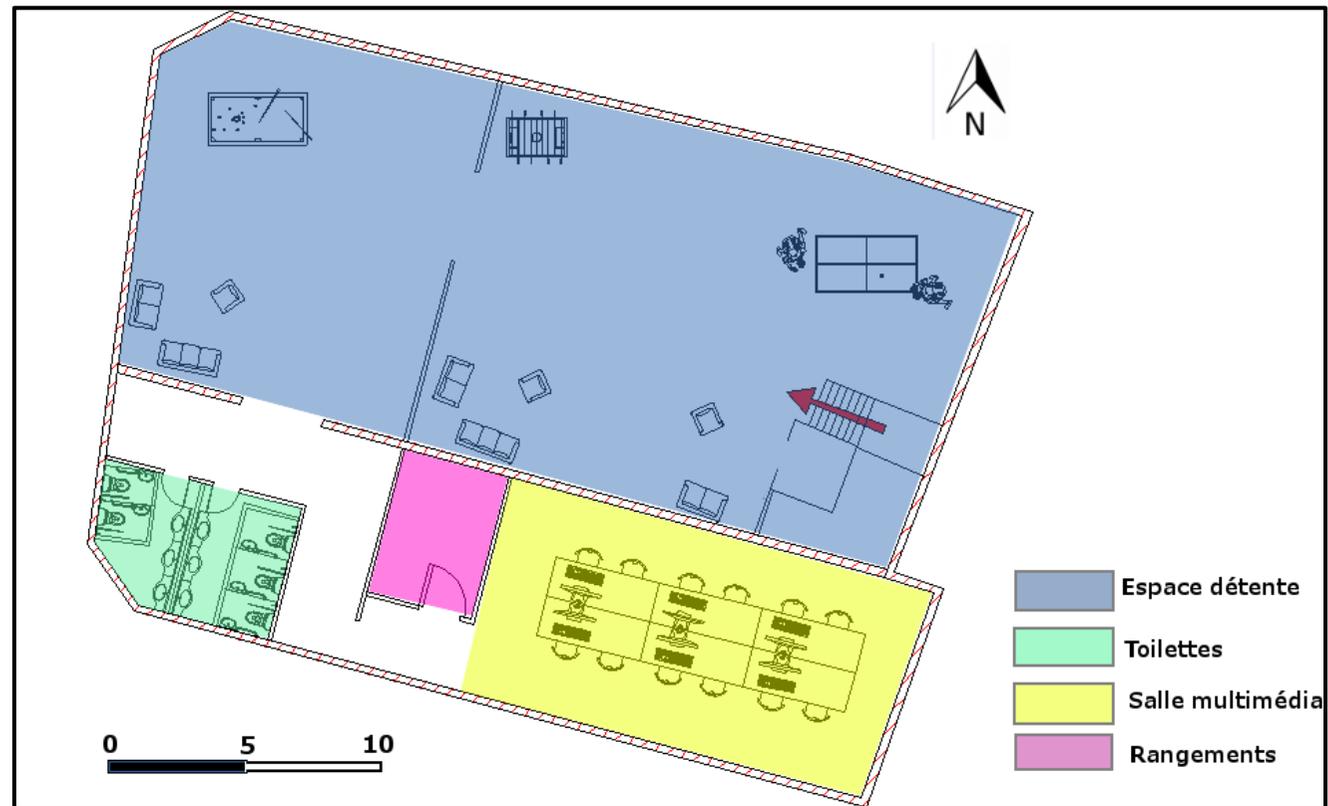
PLAN DE MASSE DU DEUXIEME ETAGE DE LA MAISON DE LA JEUNESSE
